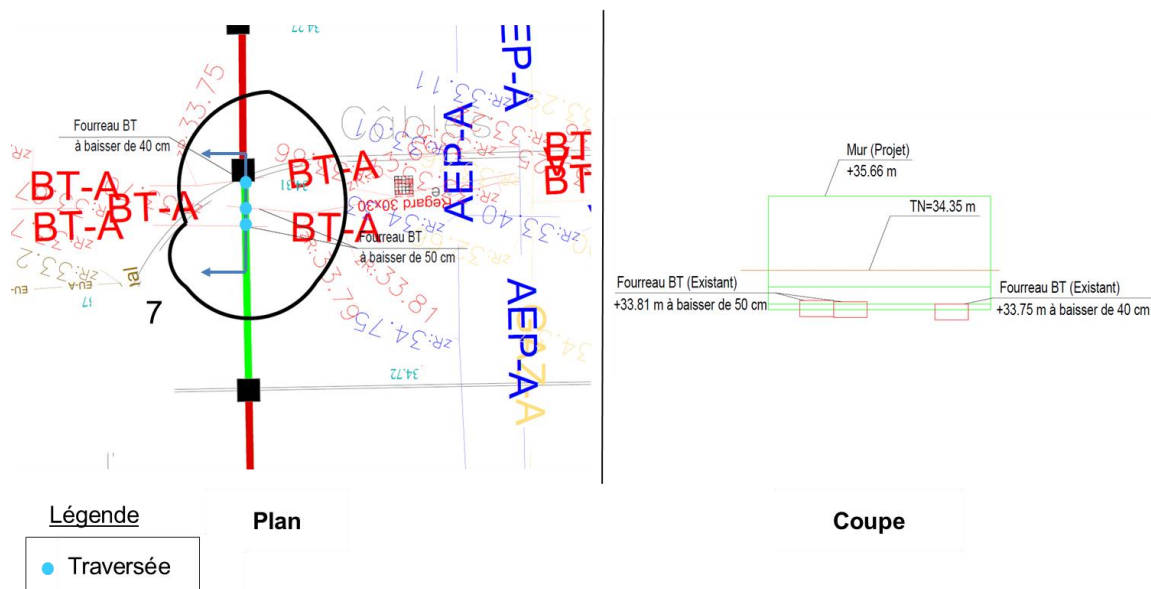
Mur traversant 3 fourreaux basse tension
